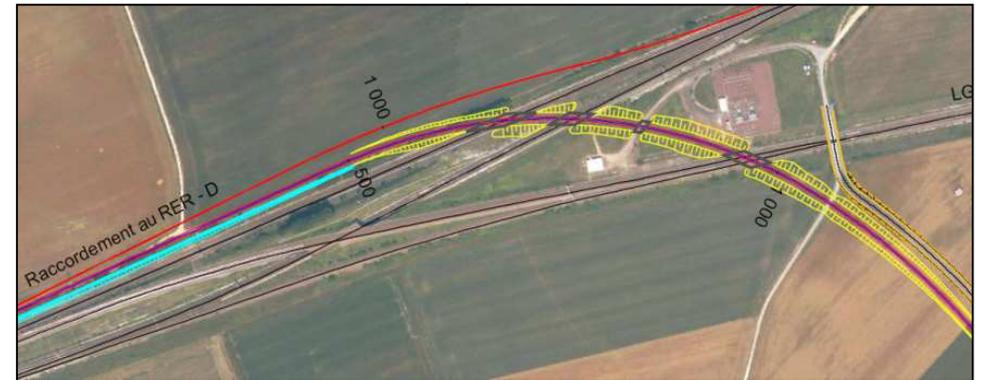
Plan du raccordement sur orthophotos, ARCADIS (sources : IGN)
